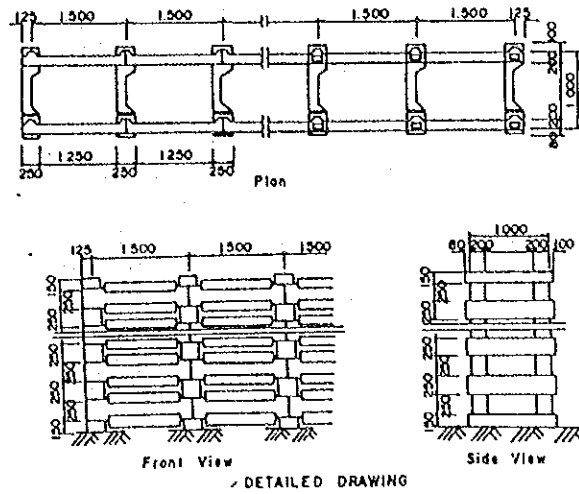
(5) Muro de contención de hormigón, tipo parrilla (Tipo 6)
